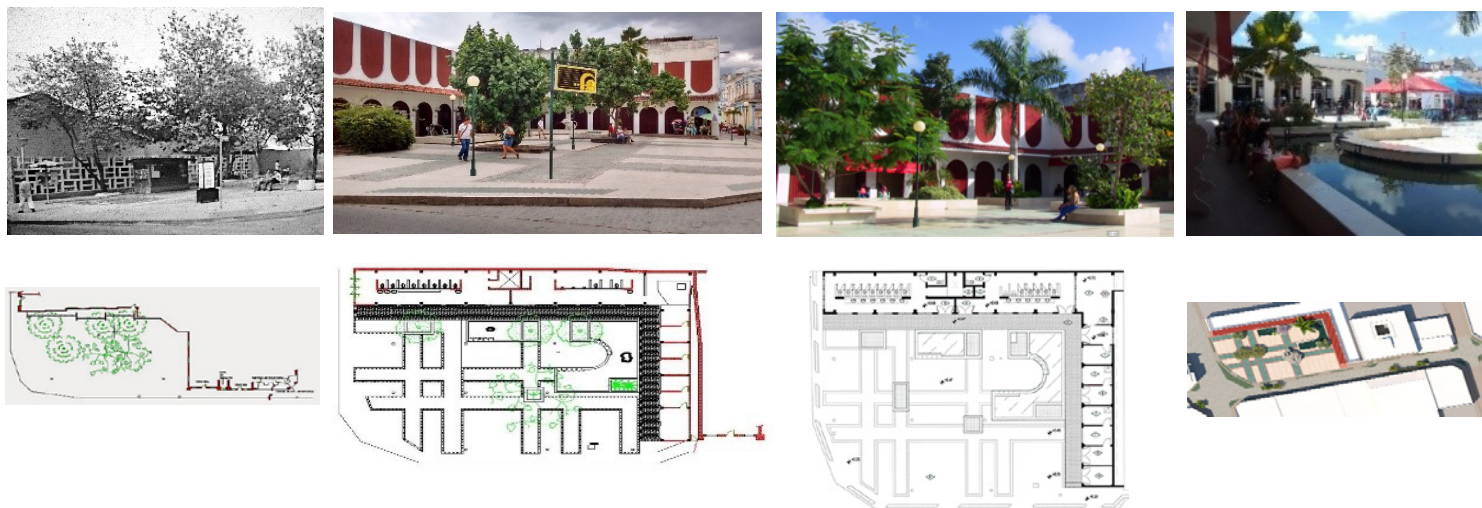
a) Vista frontal y planta Parque en esquina entre las calles Independencia y Luis Esteves. Santa Clara 1988; b) Vista frontal y planta Conjunto Cultural Plaza “Las Arcadas” 1990; c) Vista frontal y planta Primera Rehabilitación Capital Conjunto Cultural Plaza “Las Arcadas” 2004; d) Vista frontal y planta Regeneración Conjunto Cultural Plaza “Las Arcadas” Segunda rehabilitación integral a los Servicios Sanitarios Públicos, Sistema de espejos de agua y plaza cultural, Agencias de Viaje y Tienda de Artex. 2017-2019. Fotos: Arquitectos del Observatorio Urbano Equipo Técnico Boulevard de Santa Clara. Fuente: Elaboración Propia
